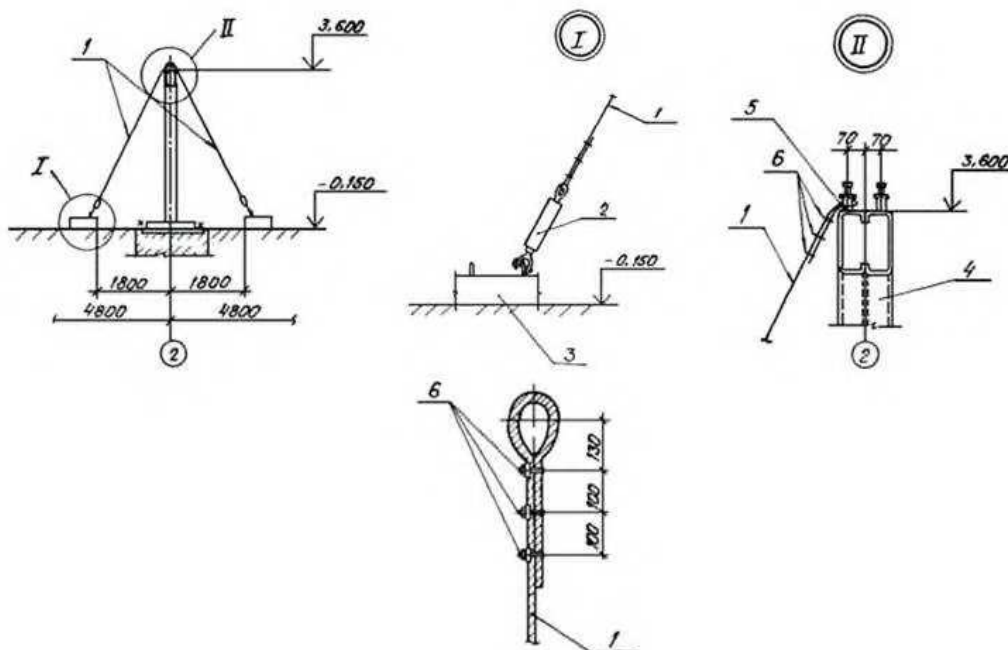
Закрепление колон при помощи расчалок 1 - расчалка из стального каната; 2 - талреп; 3 - блок фундаментный; 4 - колонна; 5 - элемент крепления панелей перекрытия; 6 - рожковый зажим
